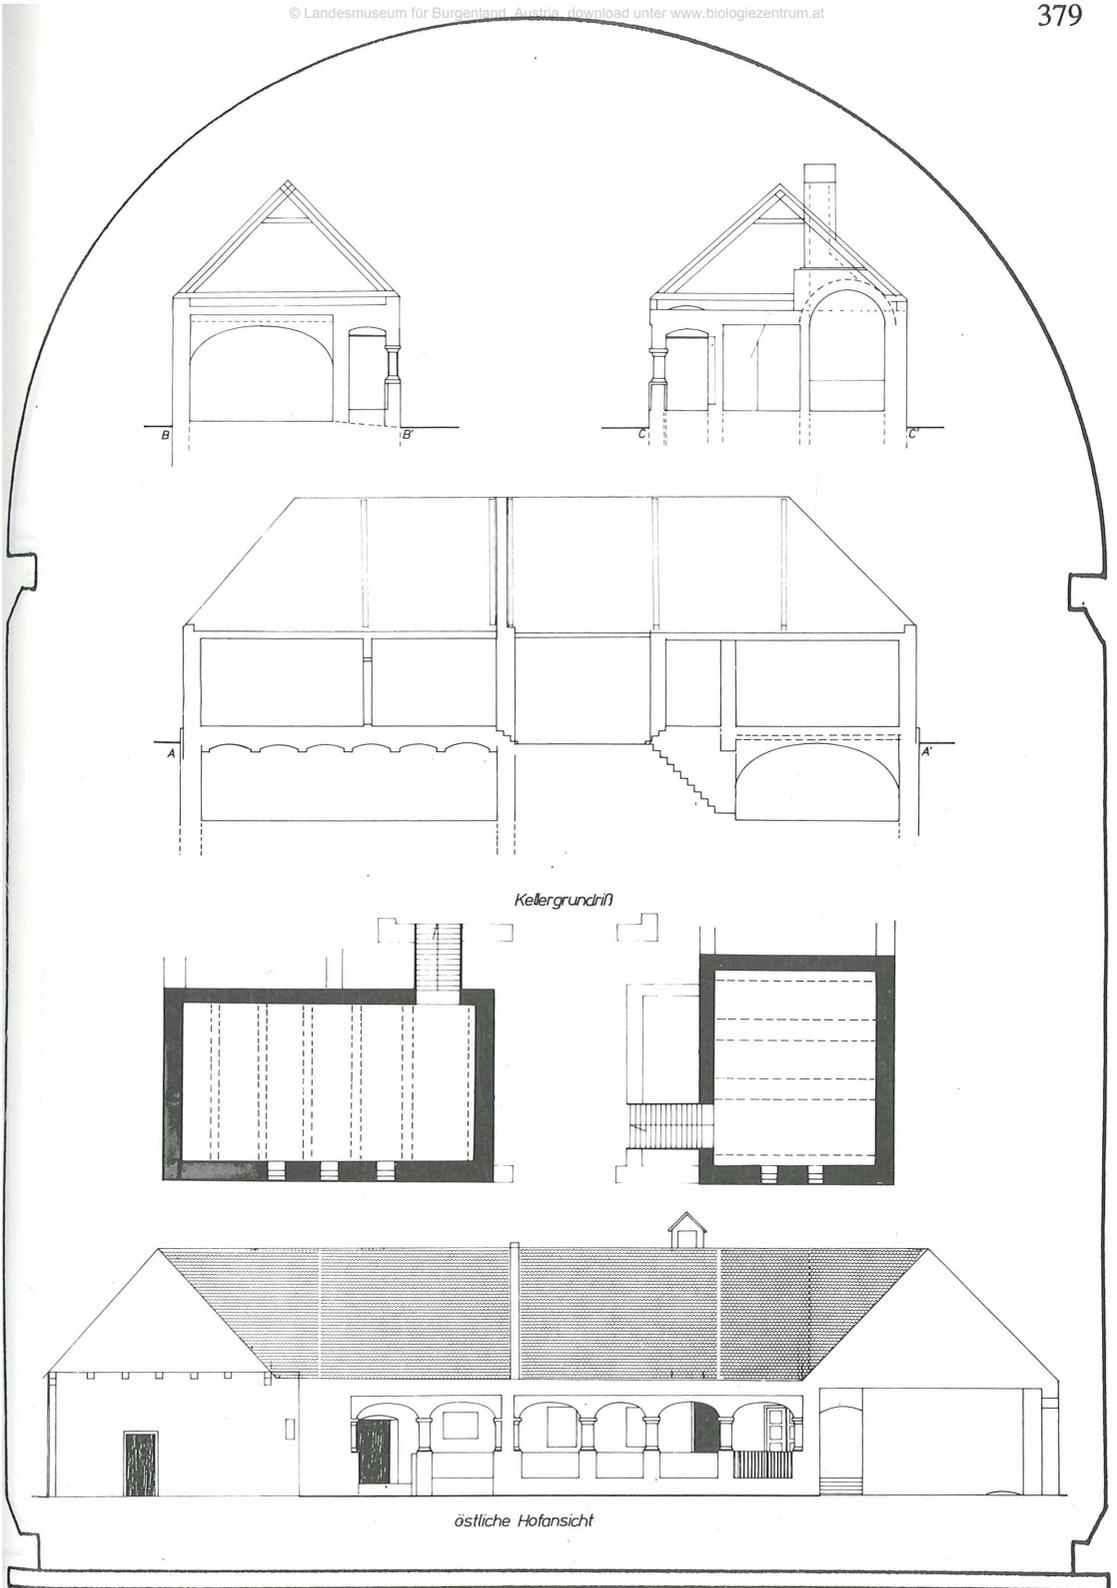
Wolfau Nr. 3 - Schnitte, Details und Lageplan
